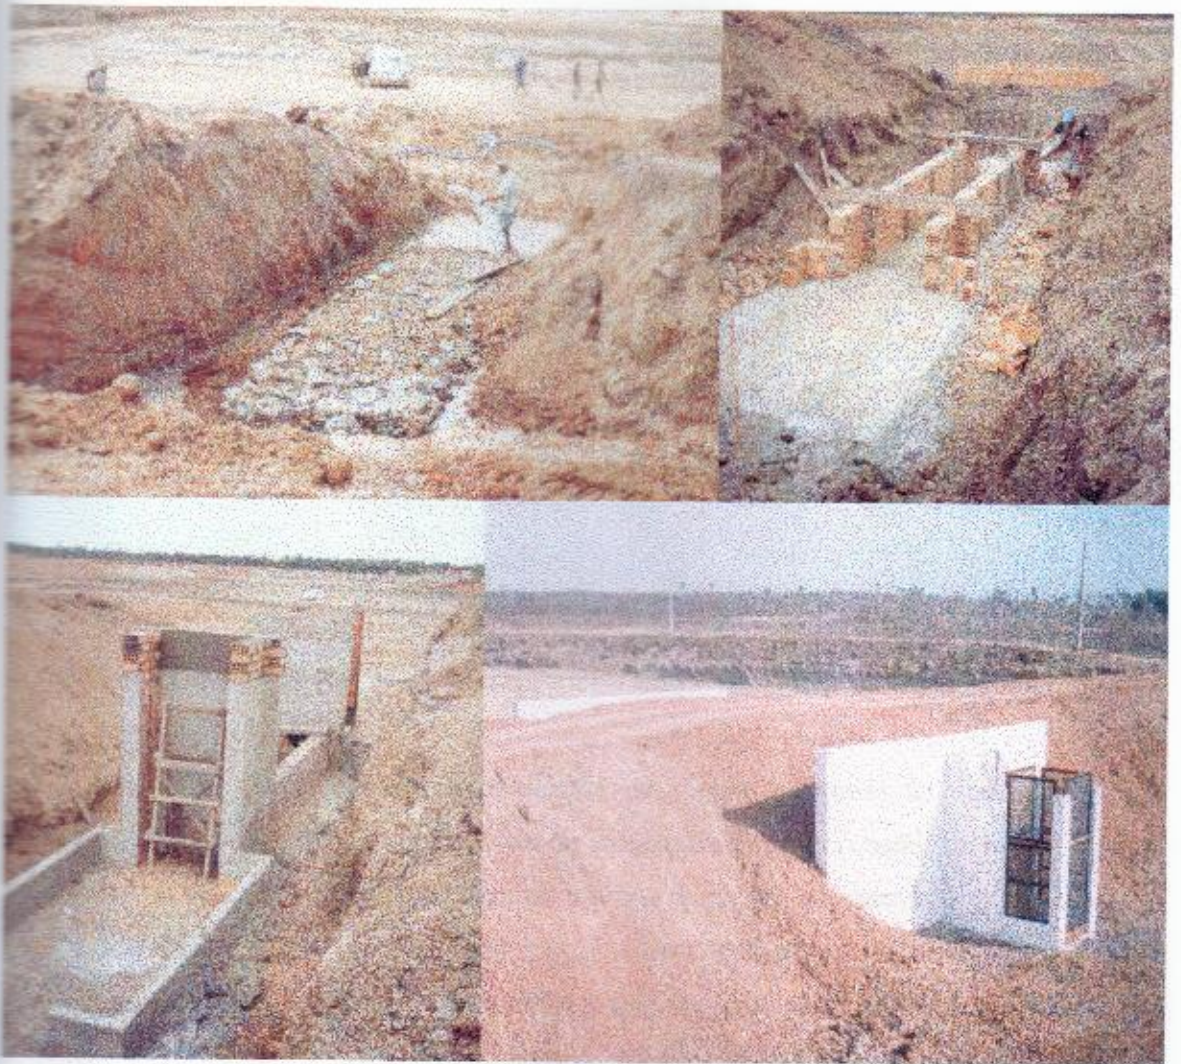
Observa-se a seqüência de construção de uma comporta de abastecimento.
